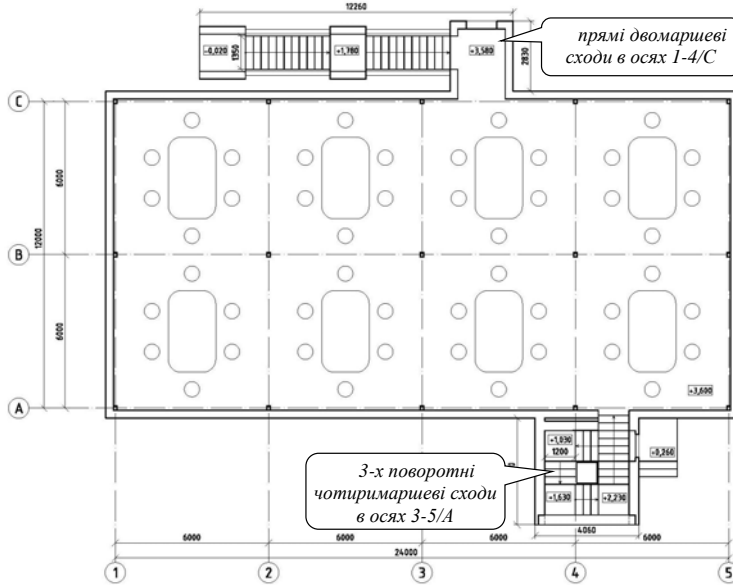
Схематичний план будівлі із вказуванням розташування сходових маршів для доступу на другий поверх
